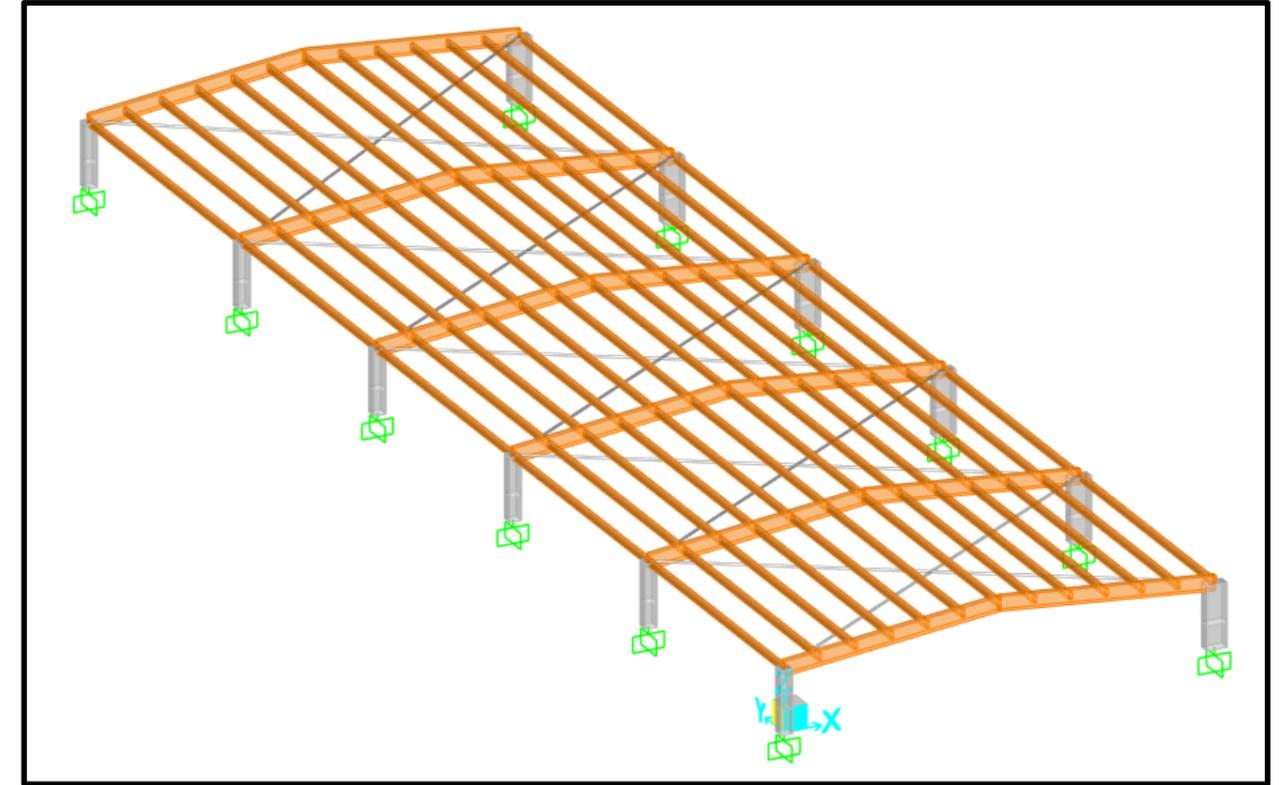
Vista 3D del modelo introducción en SAP 2000 para el cálculo de estructuras. Fuente: Elaboración propia.
